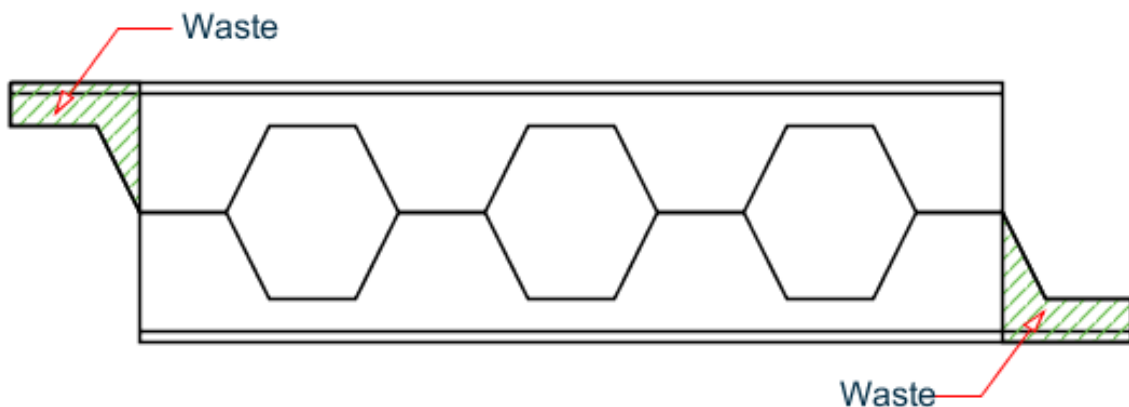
Extremos sobrante viga tras ser soldada
